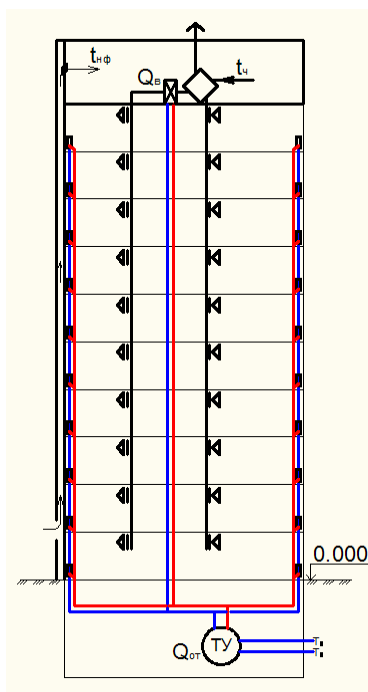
Расчетная схема отопительно-вентиляционной системы здания
